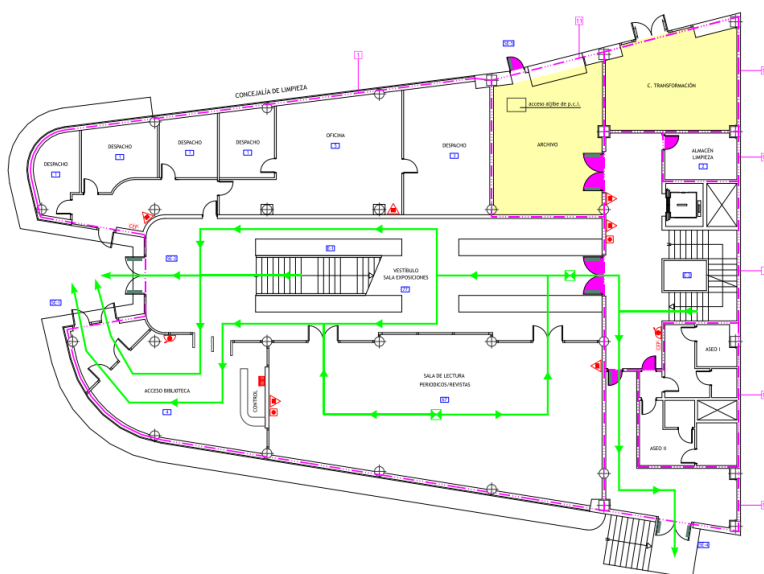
Planta Baja, Biblioteca Central Almudena Grandes
